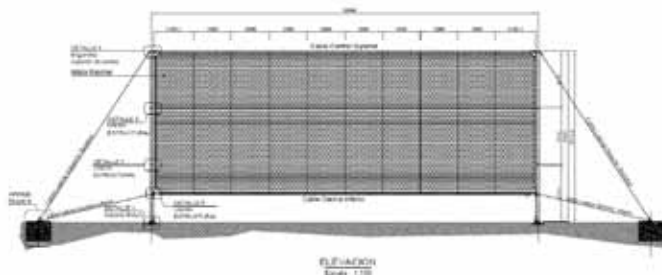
Características del atrapanieblas (Proyecto Atrapanieblas)
